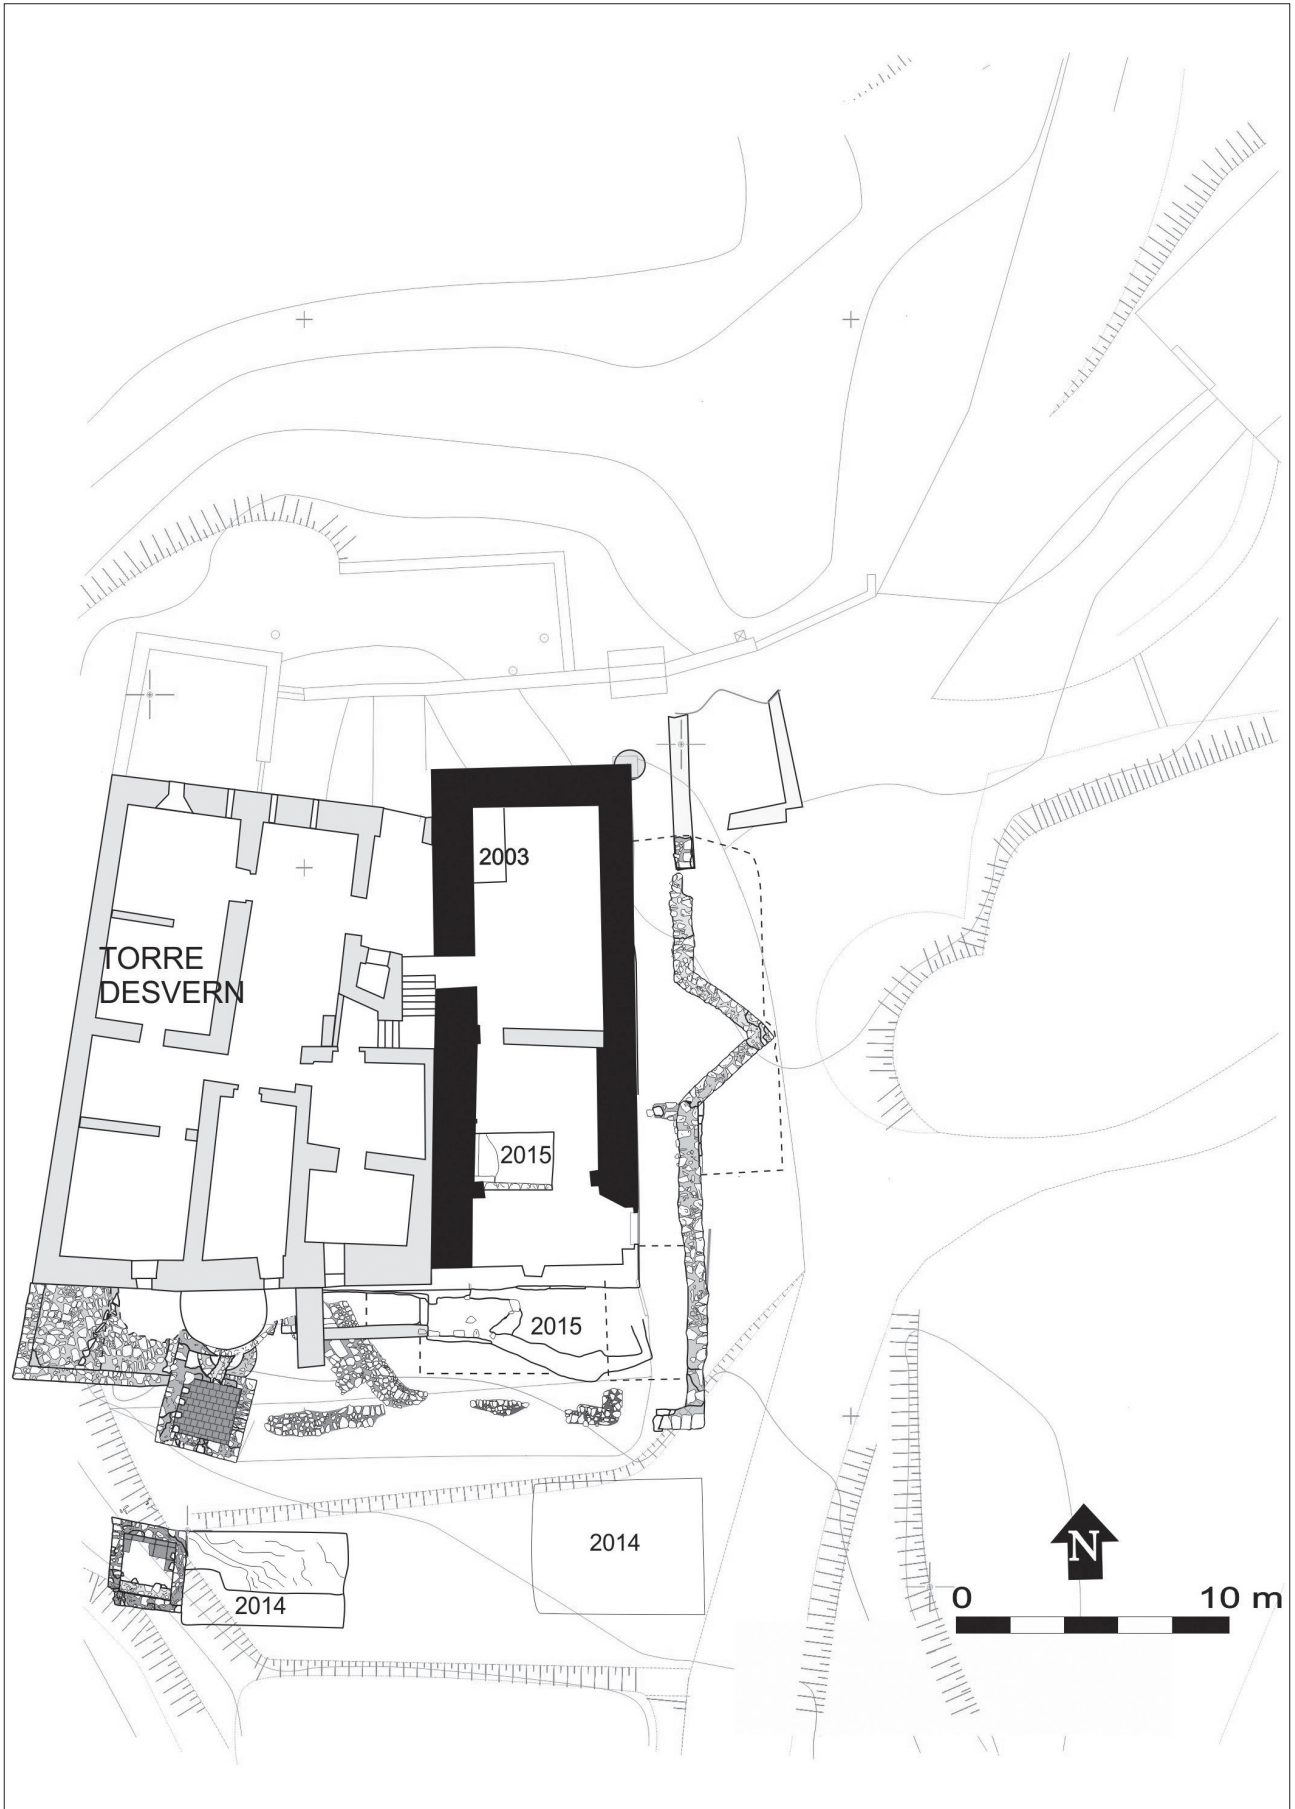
Planta general, amb indicació dels espais excavats els anys 2014-15.
